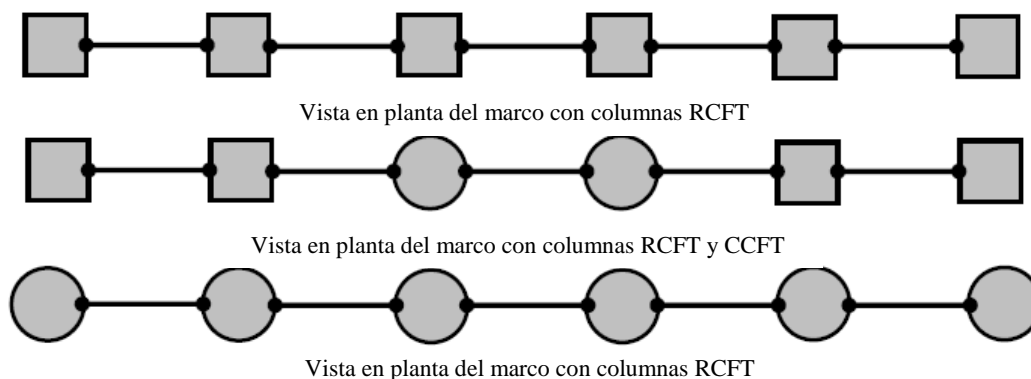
Vista en planta de los marcos en 2D (adaptada de Hu, 2008).
